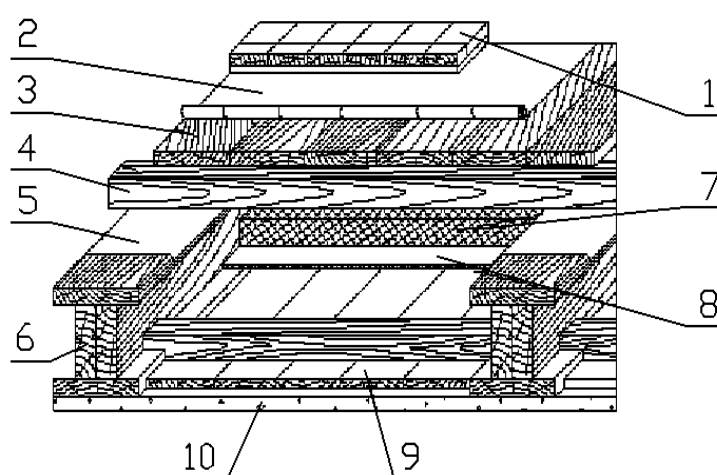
Общий вид междуэтажного перекрытия по клееным балкам:
